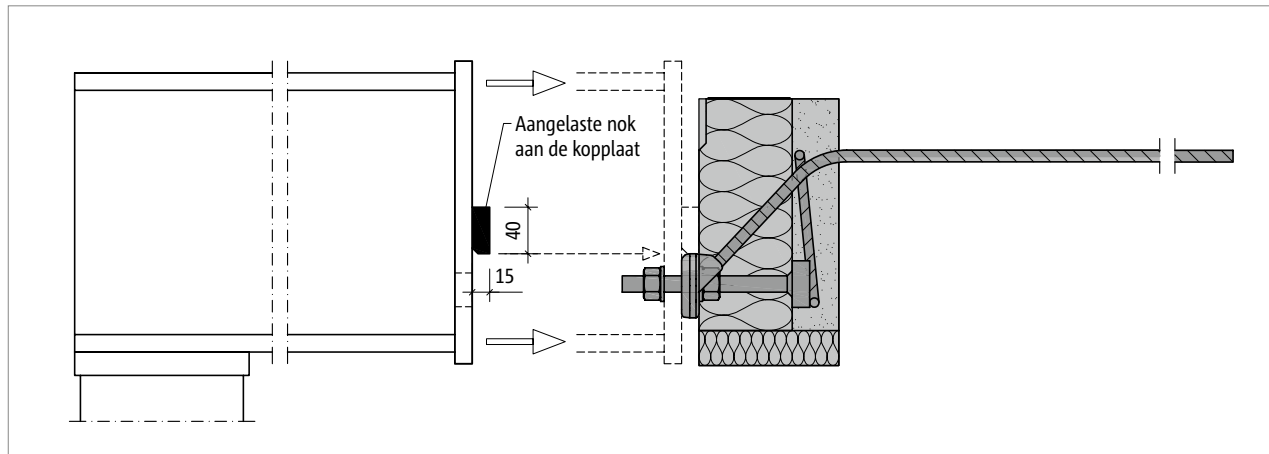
Schöck Isokorb® RT type SQ: Constructie van de kopplaat aansluiting
